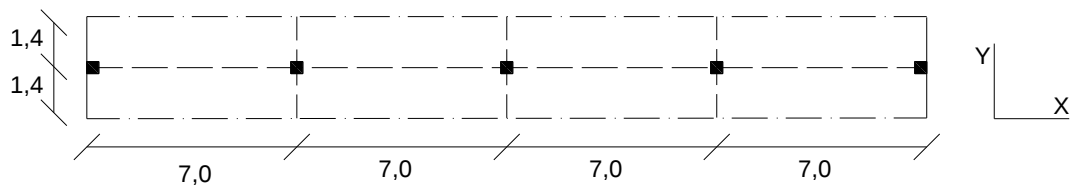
Disposição em planta do pórtico utilizado para avaliação das cargas horizontais
